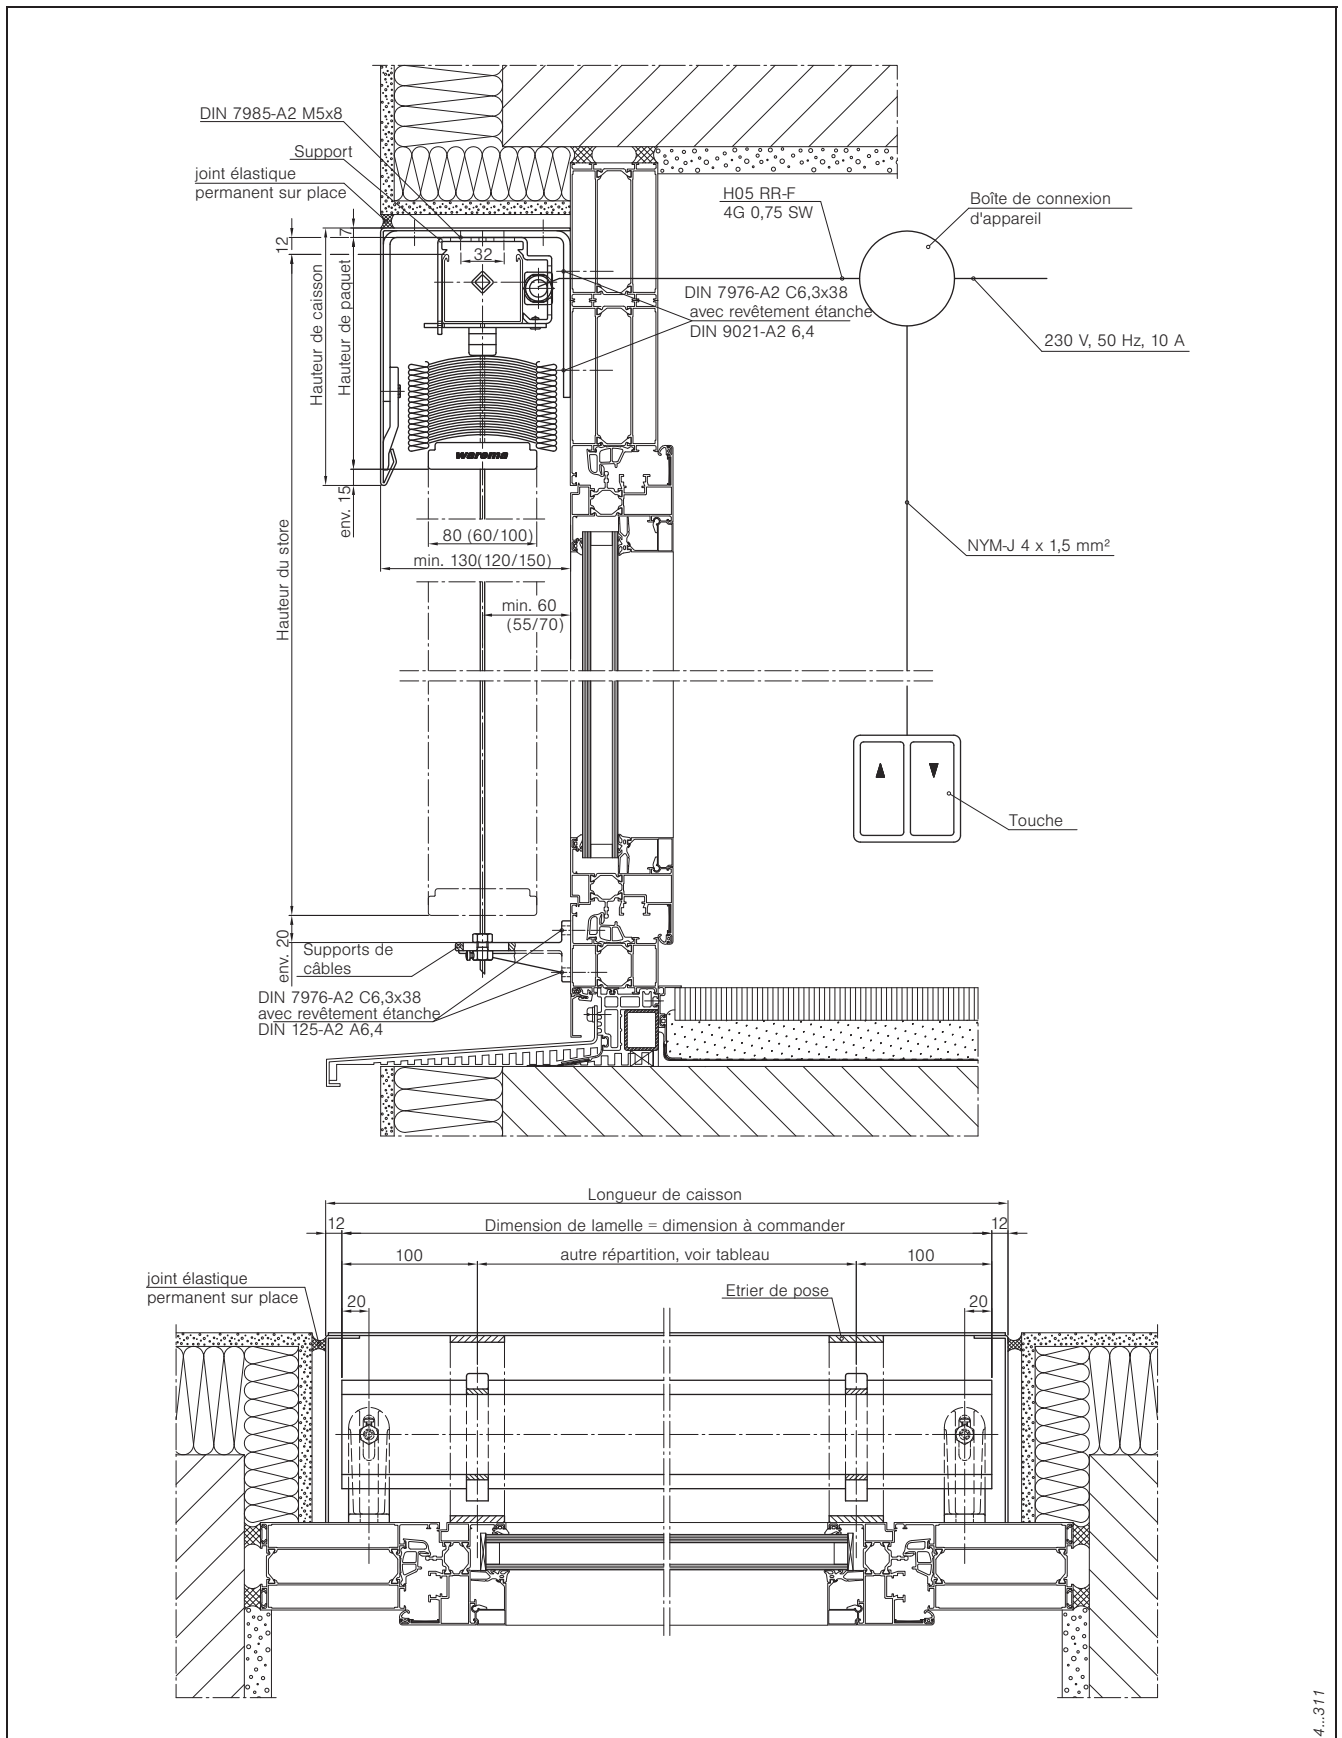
Exemple de pose brise-soleil orientables types E 60/80/100 AF avec lamelles plates dans caisson angulaire
